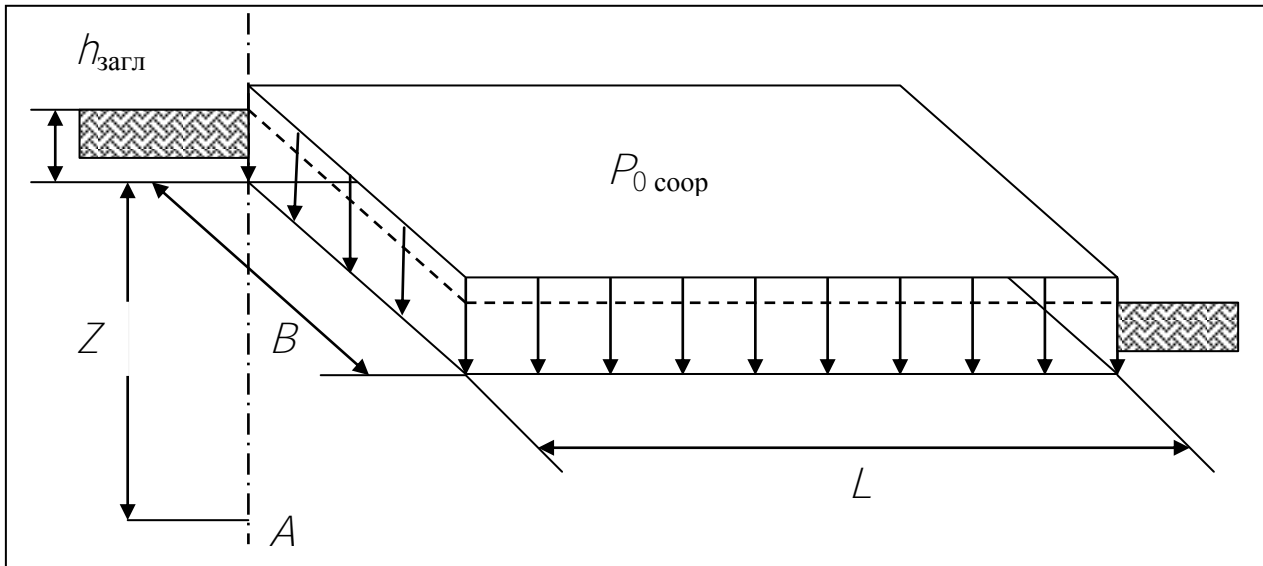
Расчетная схема определения напряжений при нагрузке, распределенной по прямоугольной площадке
